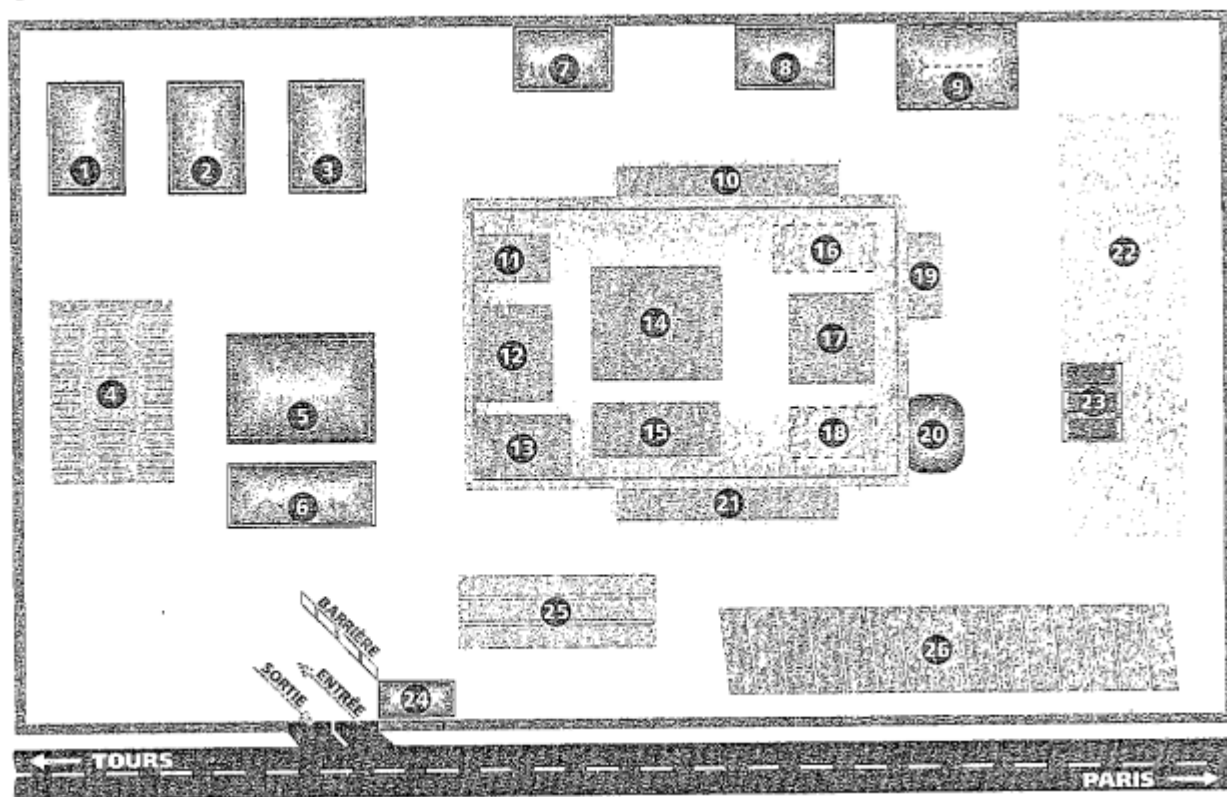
Plan du site de l'entreprise Grisal – Plan de prévention : emplacements futurs.
